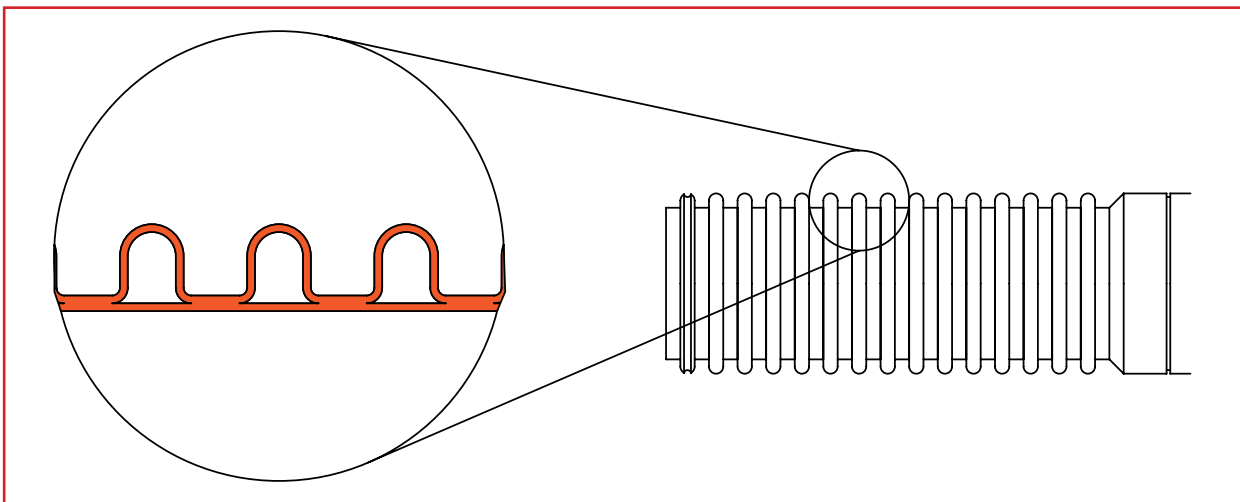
Tubería de pared estructurada de perfil abierto helicoidal
